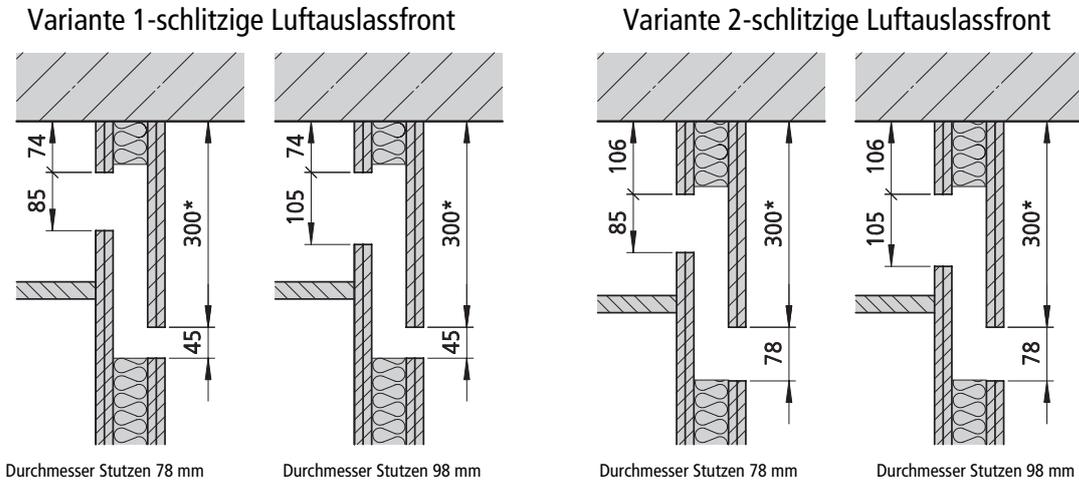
Maße Einbauöffnungen KSW (Abmessungen in mm)
